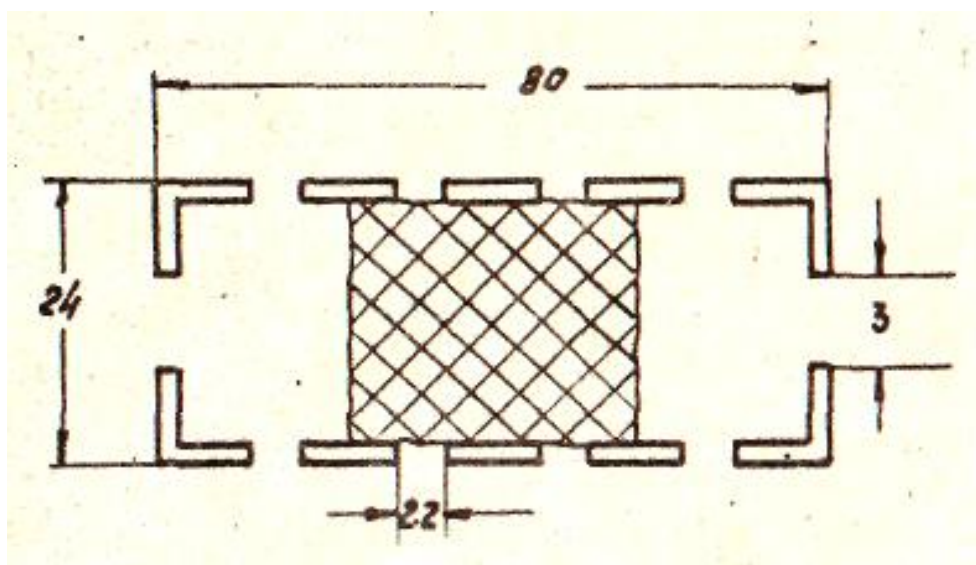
Заготовительный цех деревообрабатывающего комбината
